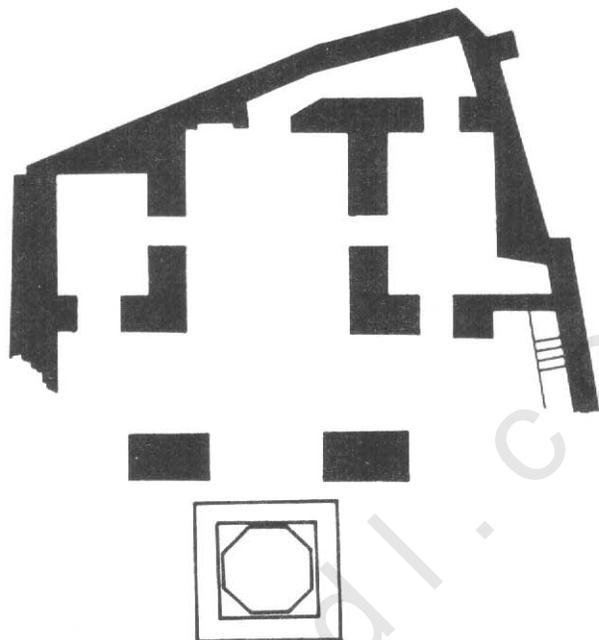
مسقط أفقي لجامع عمرو بن العاص بالفسطاط
